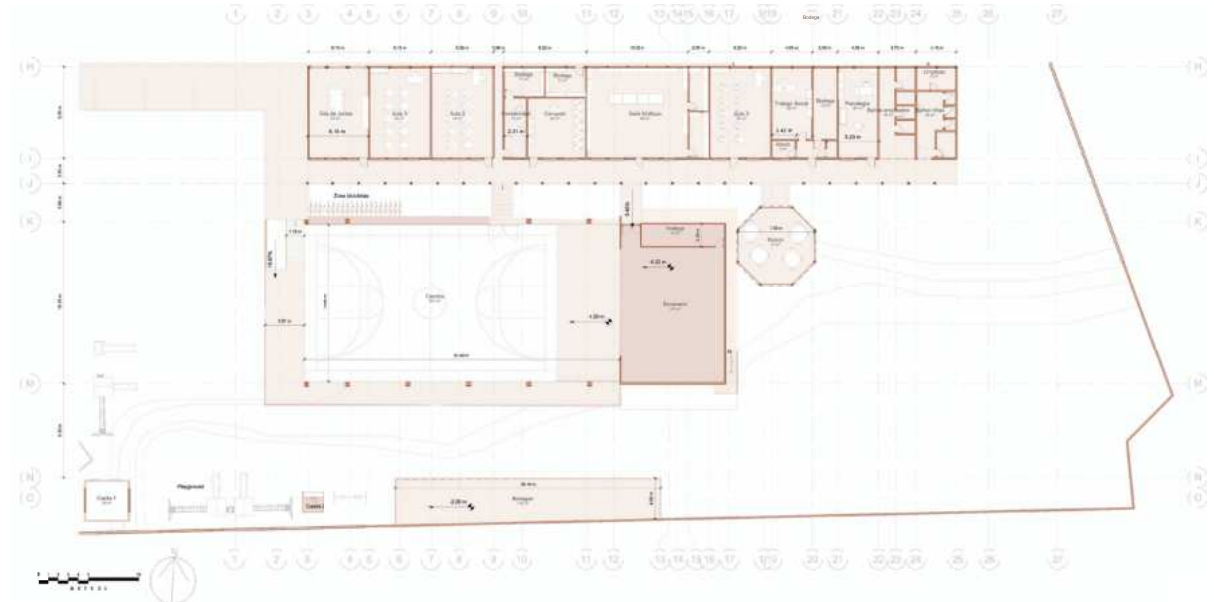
Planta de Bloque 2 Fuente: Elaboración propia
